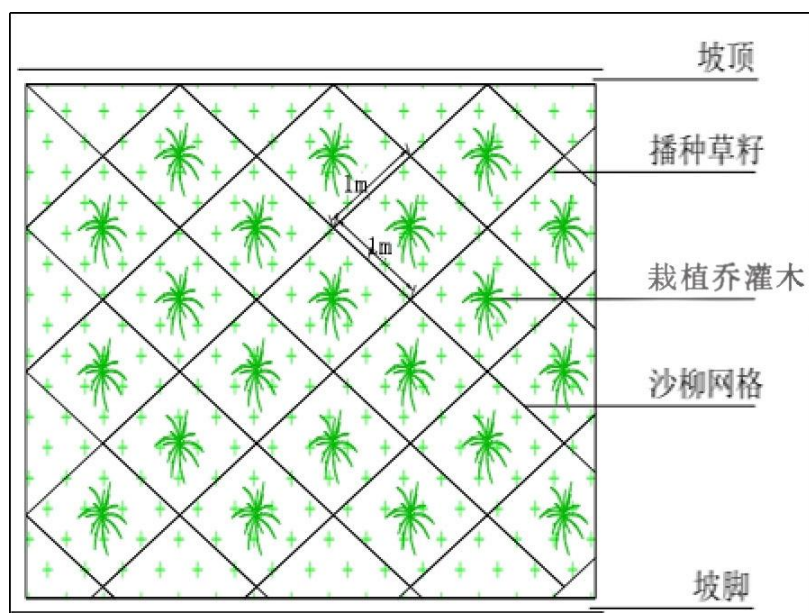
沙柳格网护坡设计示意图（单位：cm）
